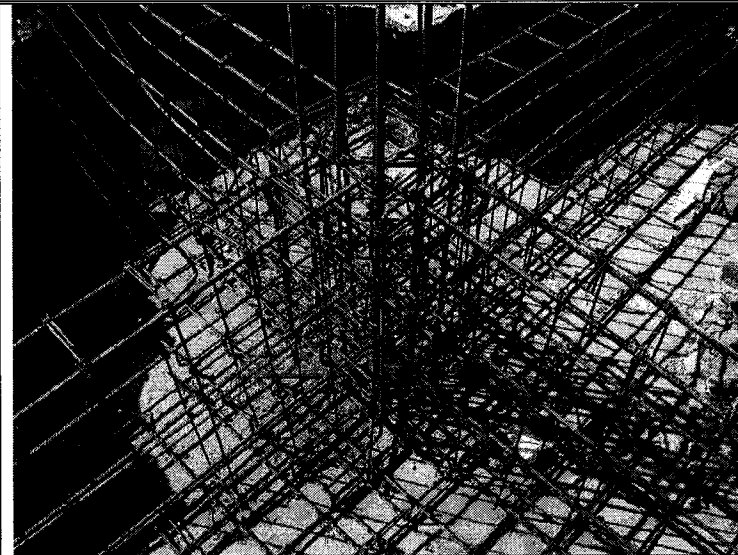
Colado de Cimentación de Viviendas de Enfrente
